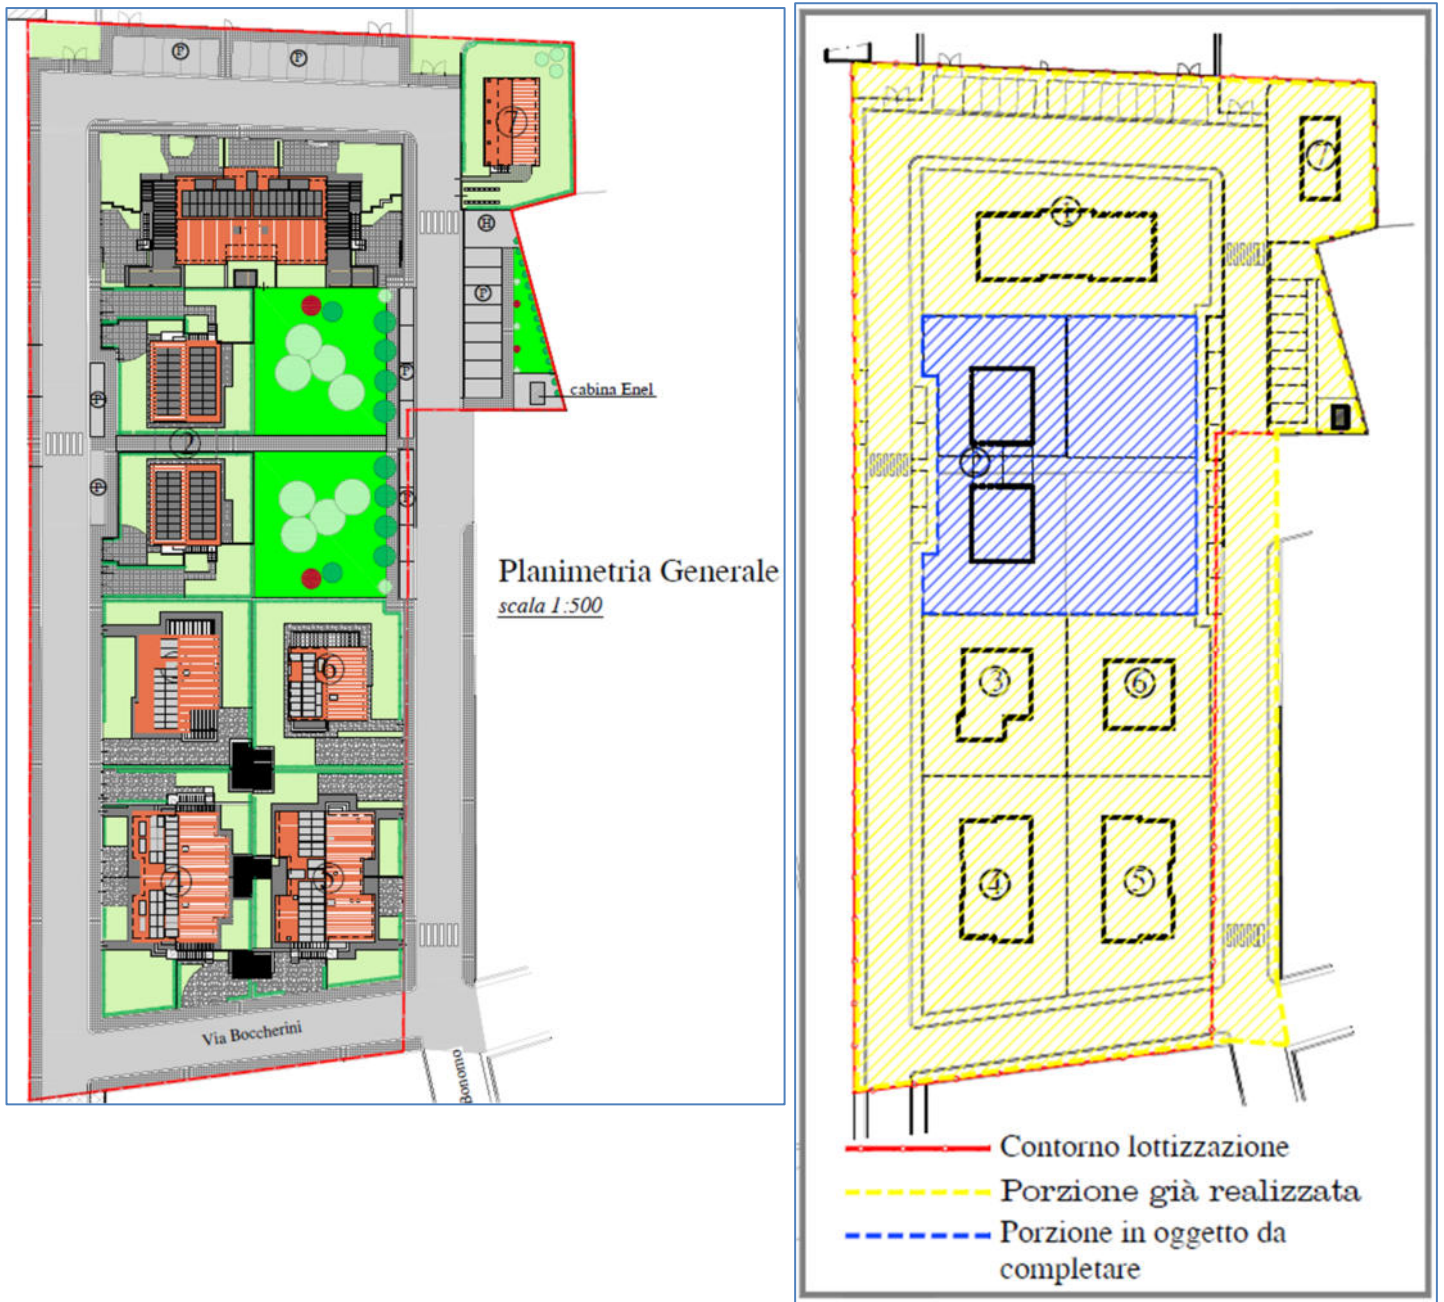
Planimetria di progetto e individuazione Lotto 2 oggetto di variante al POC
